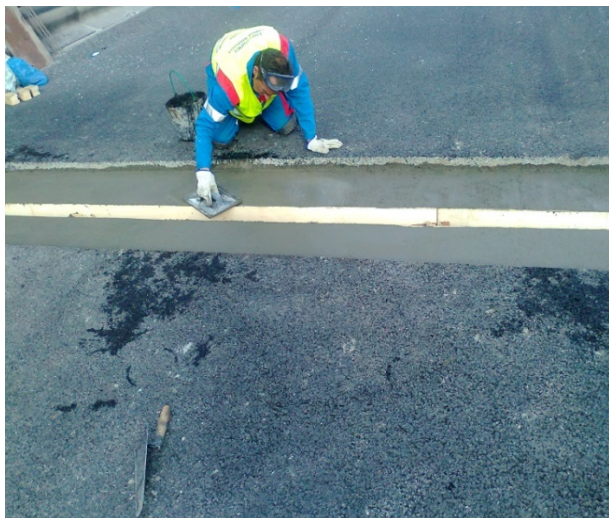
Preenchimento e alisamento da área de suporte da JD com grout – Av. Lusíada
